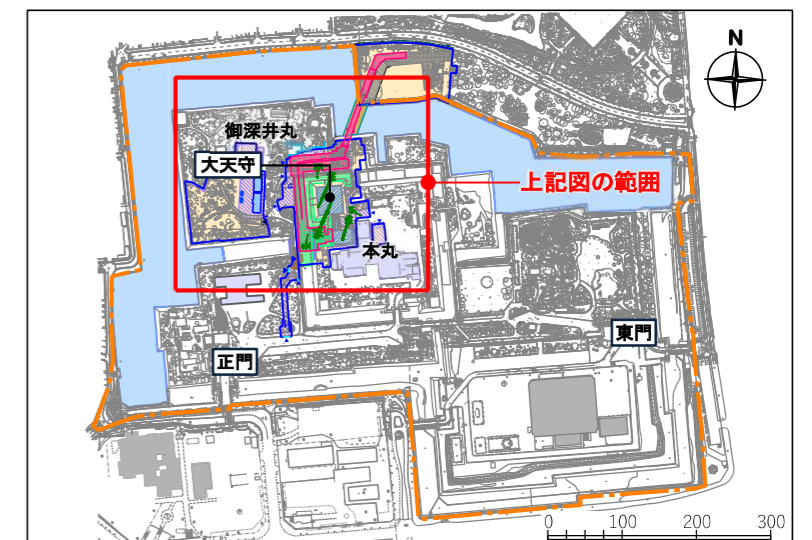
現天守閣解体工事時の平面図(敷地全体)
